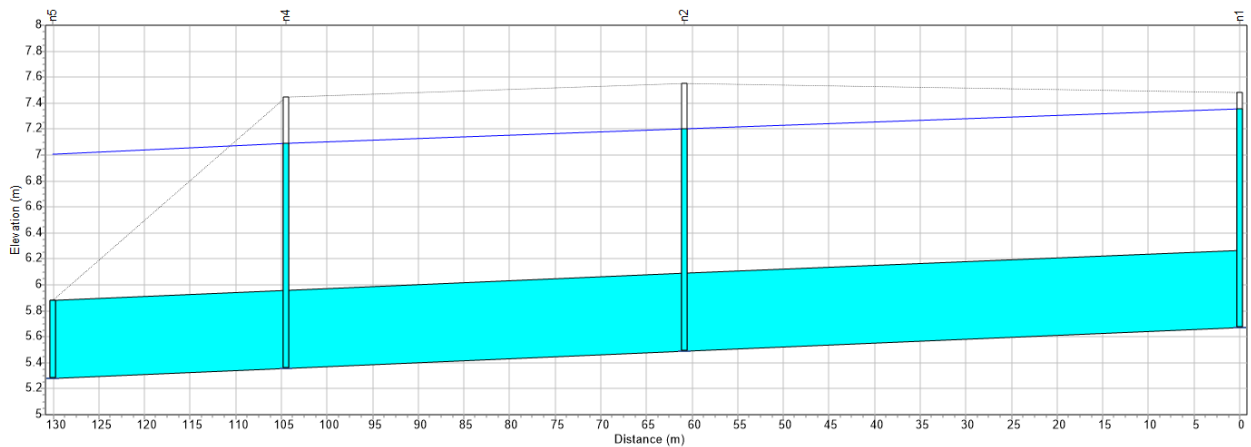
Perfil longitudinal del colector sur (descarga libre)
